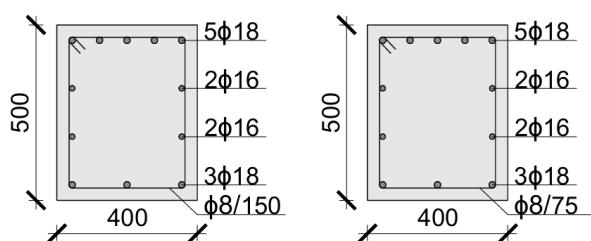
Sezioni trasversali tipo delle travi con dettaglio dell'armatura longitudinale e trasversale – sezioni 2' e 3'.
